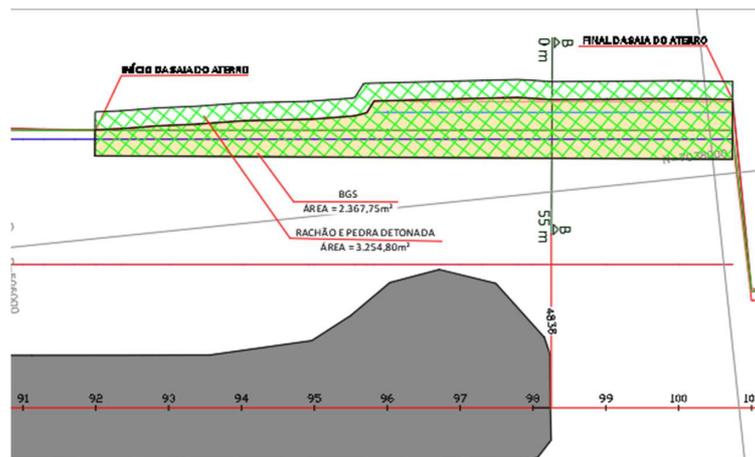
Planta do aterro compactado entre as Estacas 92 e 100 + 14m
